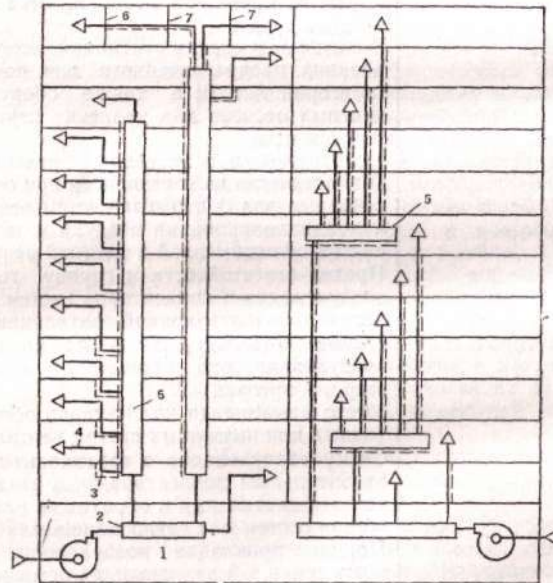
Схема систем вентиляции для многоэтажных зданий
